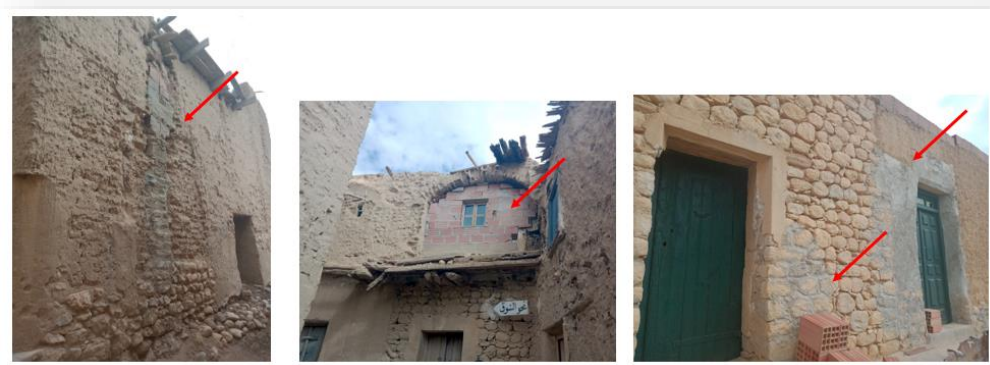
Interventions volontaires par les propriétaires. Source : Auteure.2022.
